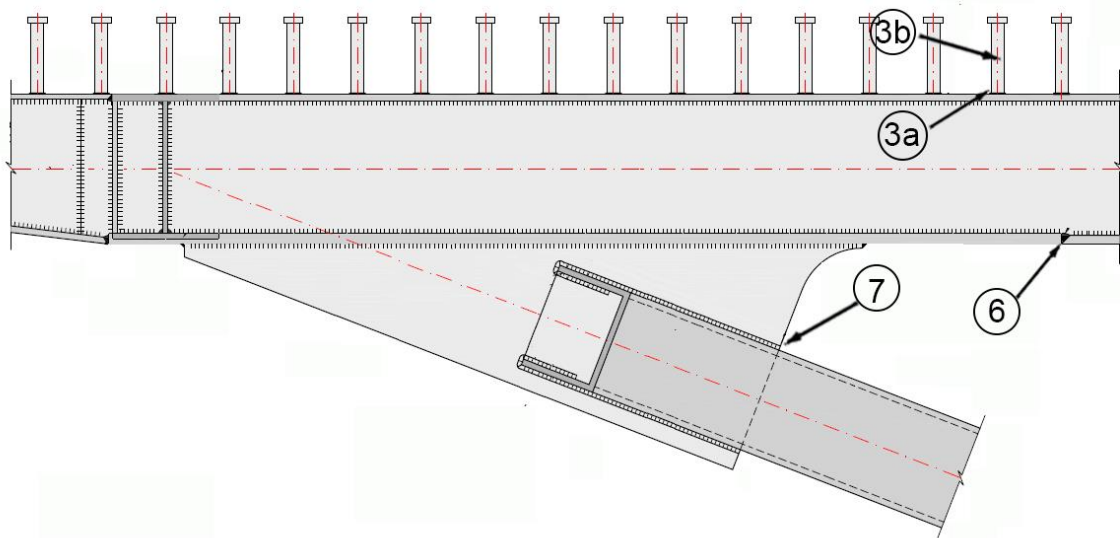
Pormenores críticos na zona de ligação da escora à travessa superior
